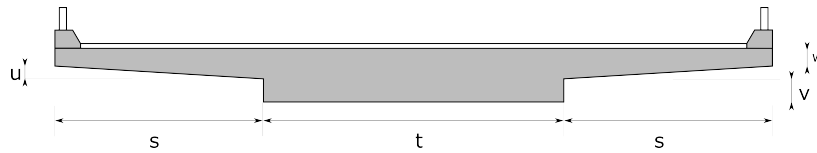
Configuración de la losa maciza de concreto reforzado para puentes convencionales
